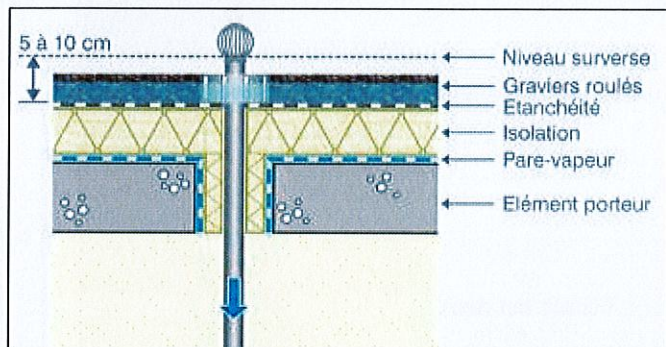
Exemple de constitution de toiture stockante (SPW)
